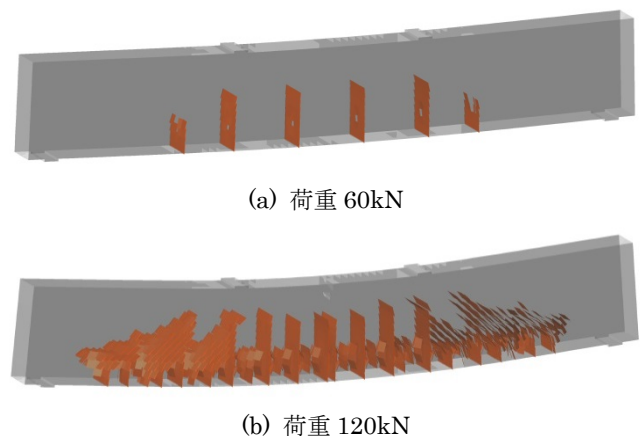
回転ひび割れモデル ひび割れ図 (梁の曲げ試験)
